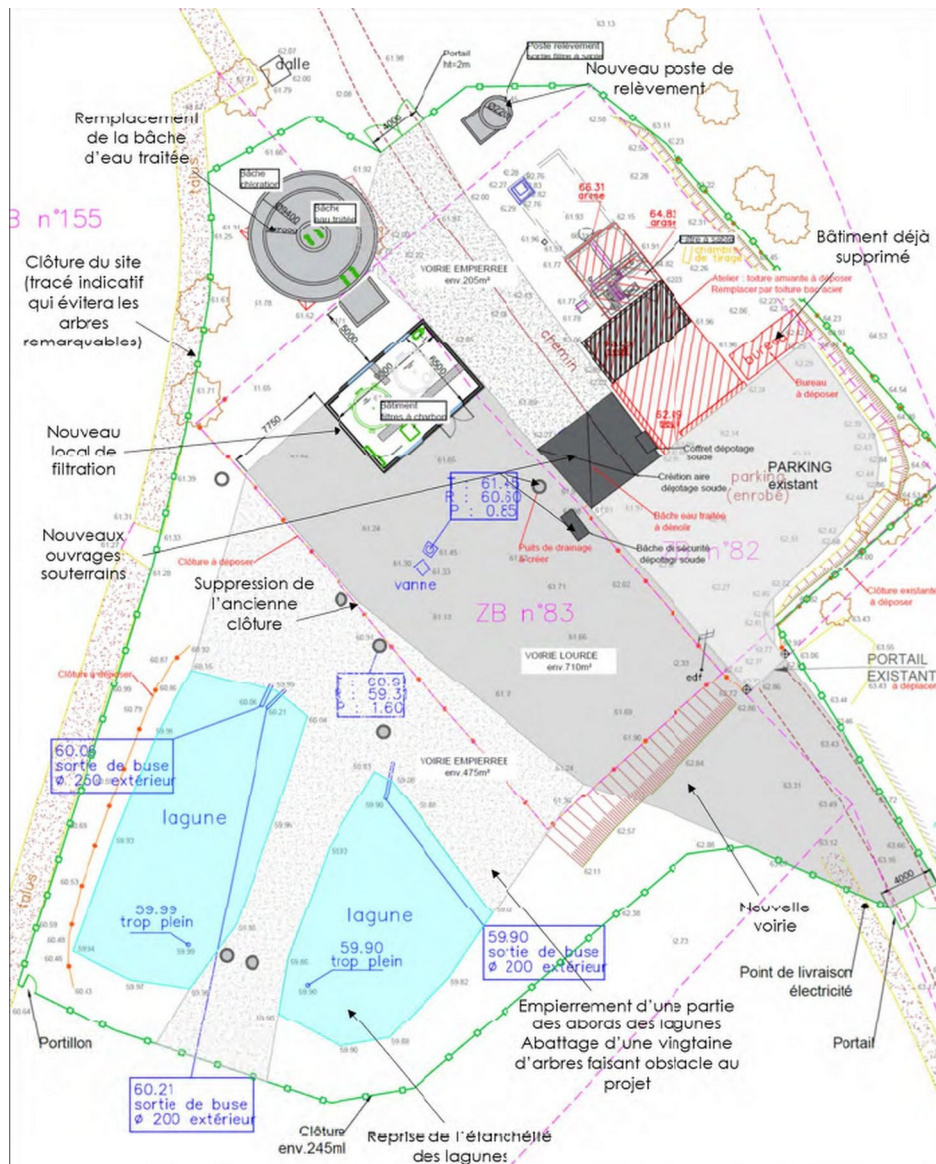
Plan d'implantation au stade d'avant-projet (source dossier)
